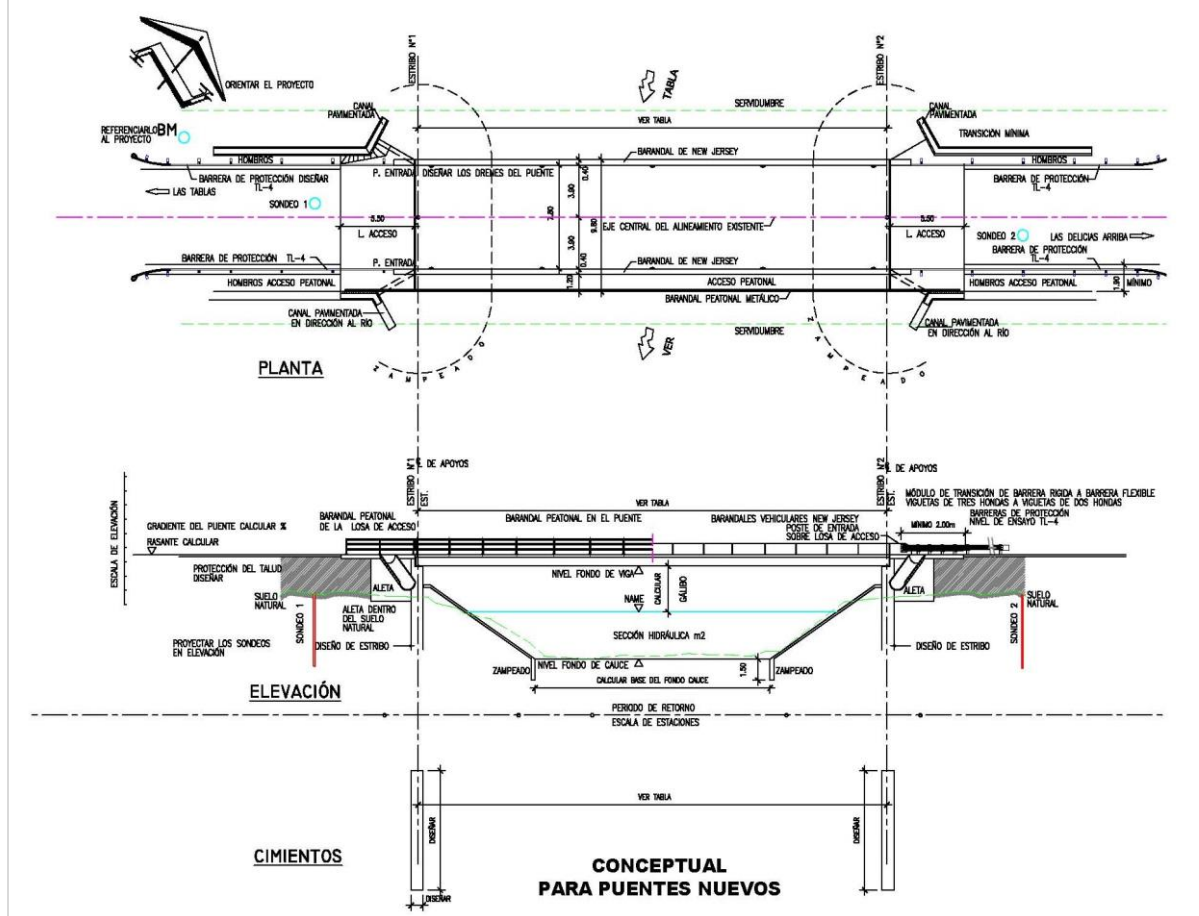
Vista de los puentes vehiculares nuevos a construir. Fuente: Equipo Consultor. 2020
